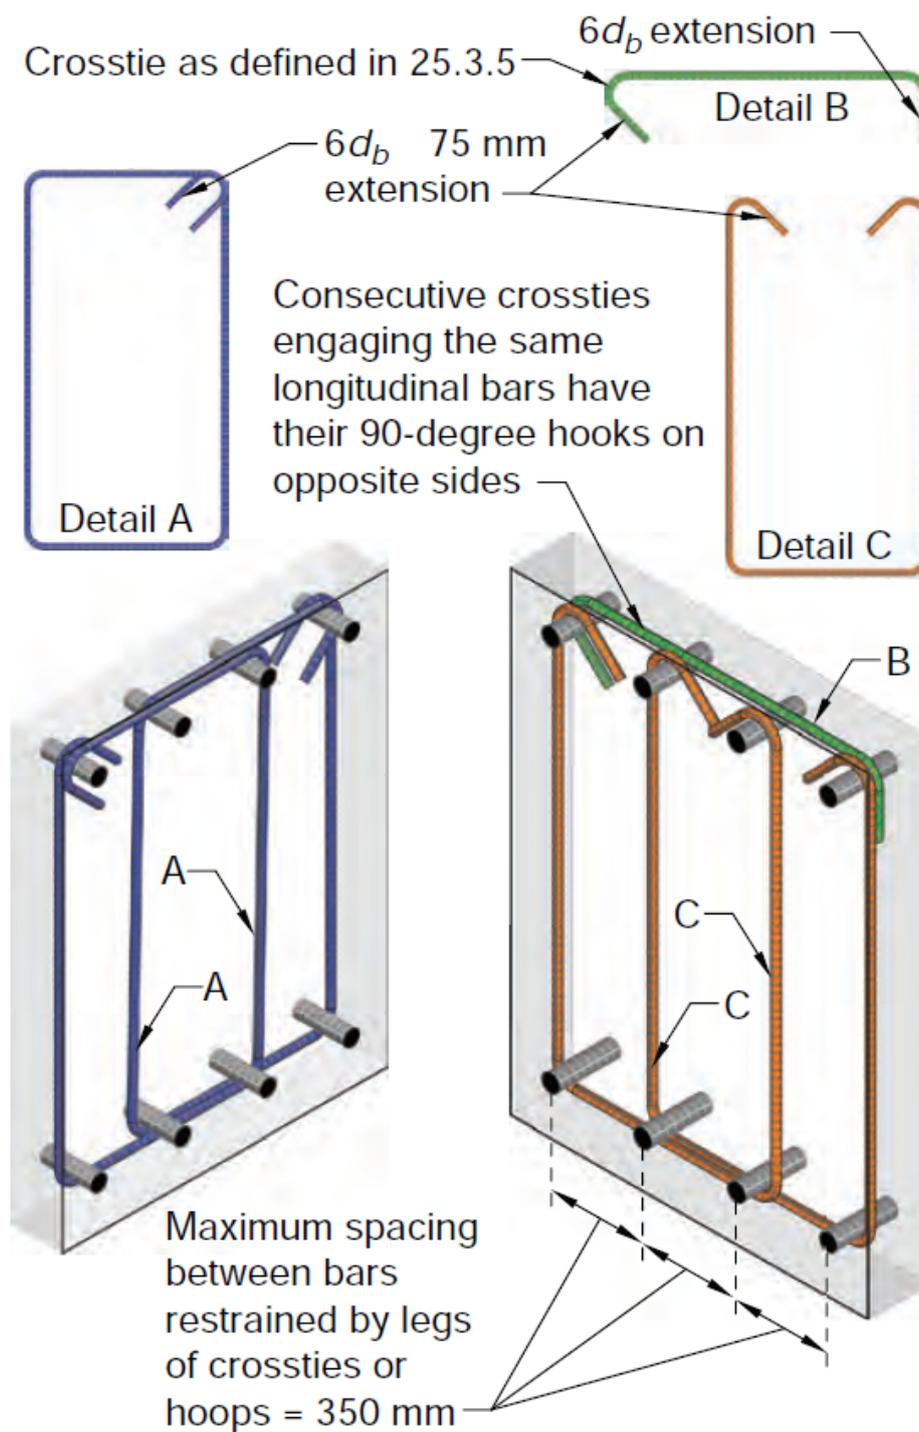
ACI 318-19 (SI)建議 RC 梁閉合箍筋示意圖
